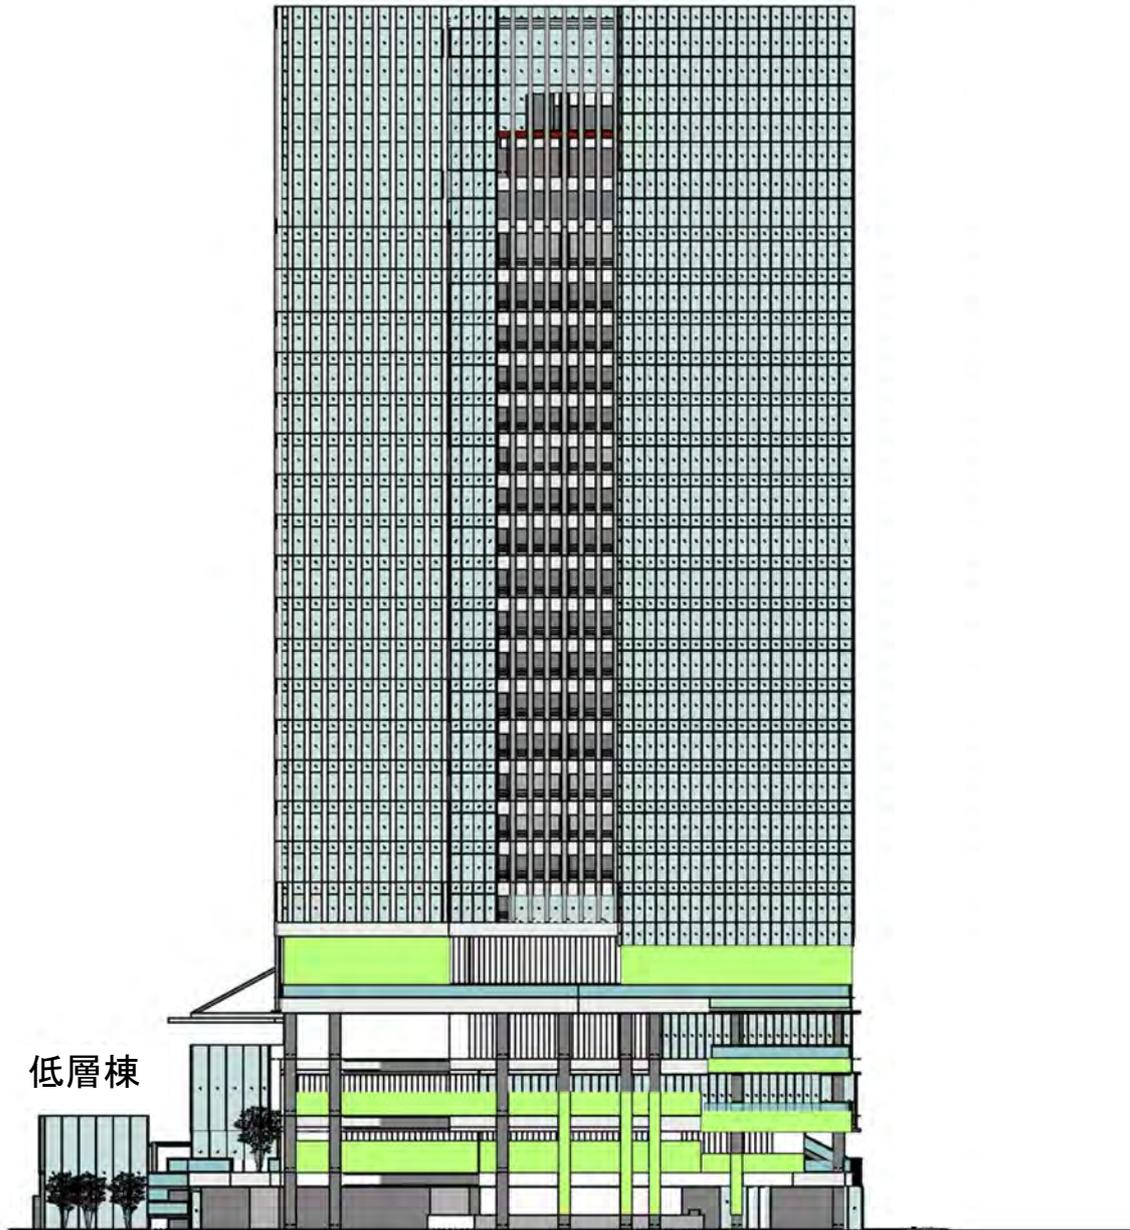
(2) 立面图 (東立面图 S=1:800) 【变更前】
